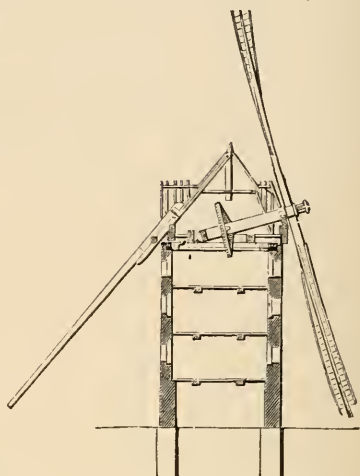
Coupe verticale d'un moulin à vent à toit tournant.
